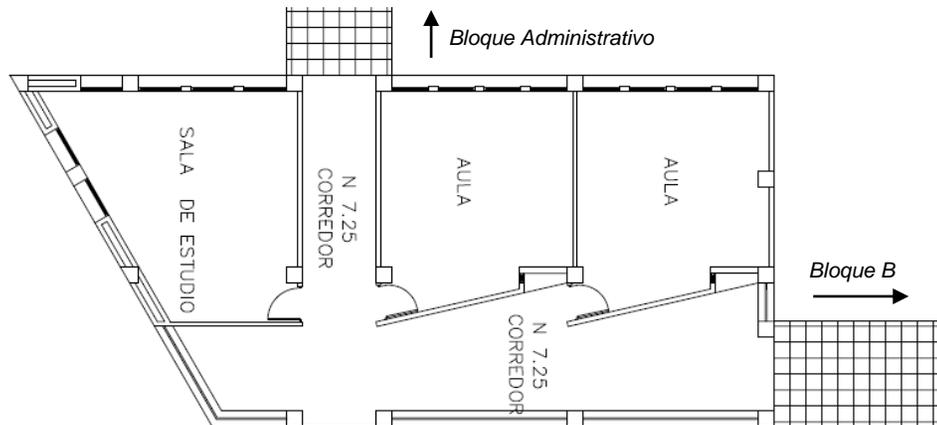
Distribución arquitectónica vista en planta Bloque A
